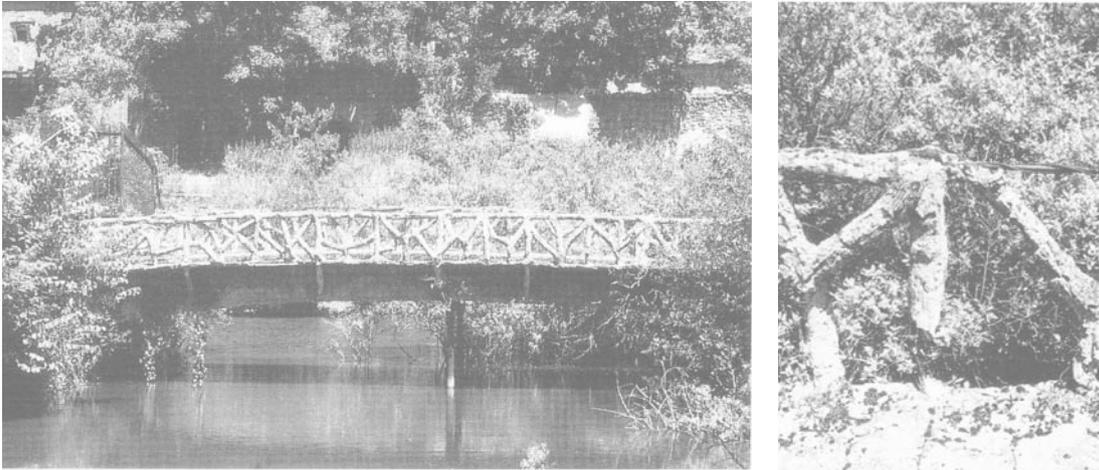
und 105: Monierbrücke in Chazelet, erbaut 1875 (rechts Detail mit freiliegender Bewehrung)
